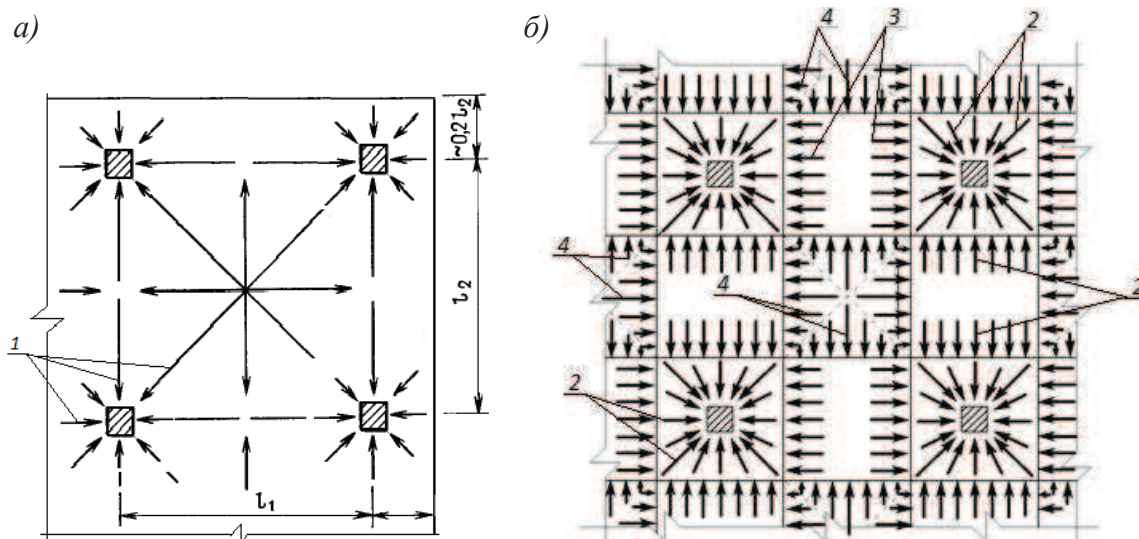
Розрахункові схеми передавання навантаження в безкапітально-безбалковому каркасі: а) монолітному; б) збірному; 1 – на колони монолітного каркаса; 2 – з надколонних плит на колону; 3 – з міжколонних плит на надколонні плити; 4 – із середніх плит на міжколонні плити
